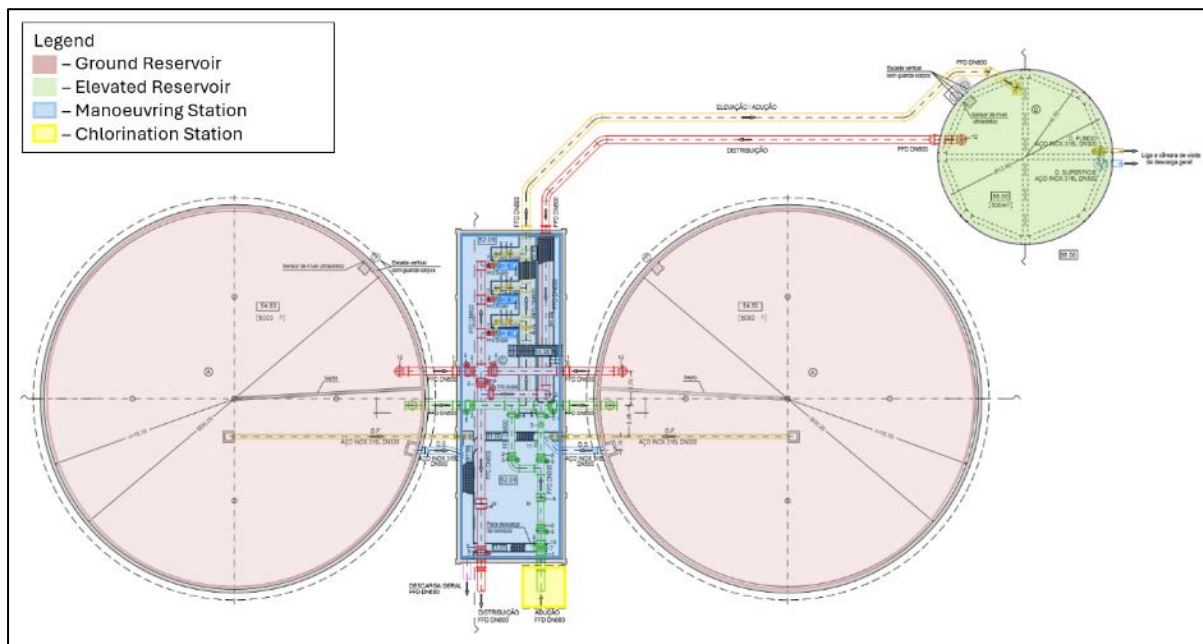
Vista aérea das infra-estruturas hidráulicas (Fonte: CentroCerro, 2025)
